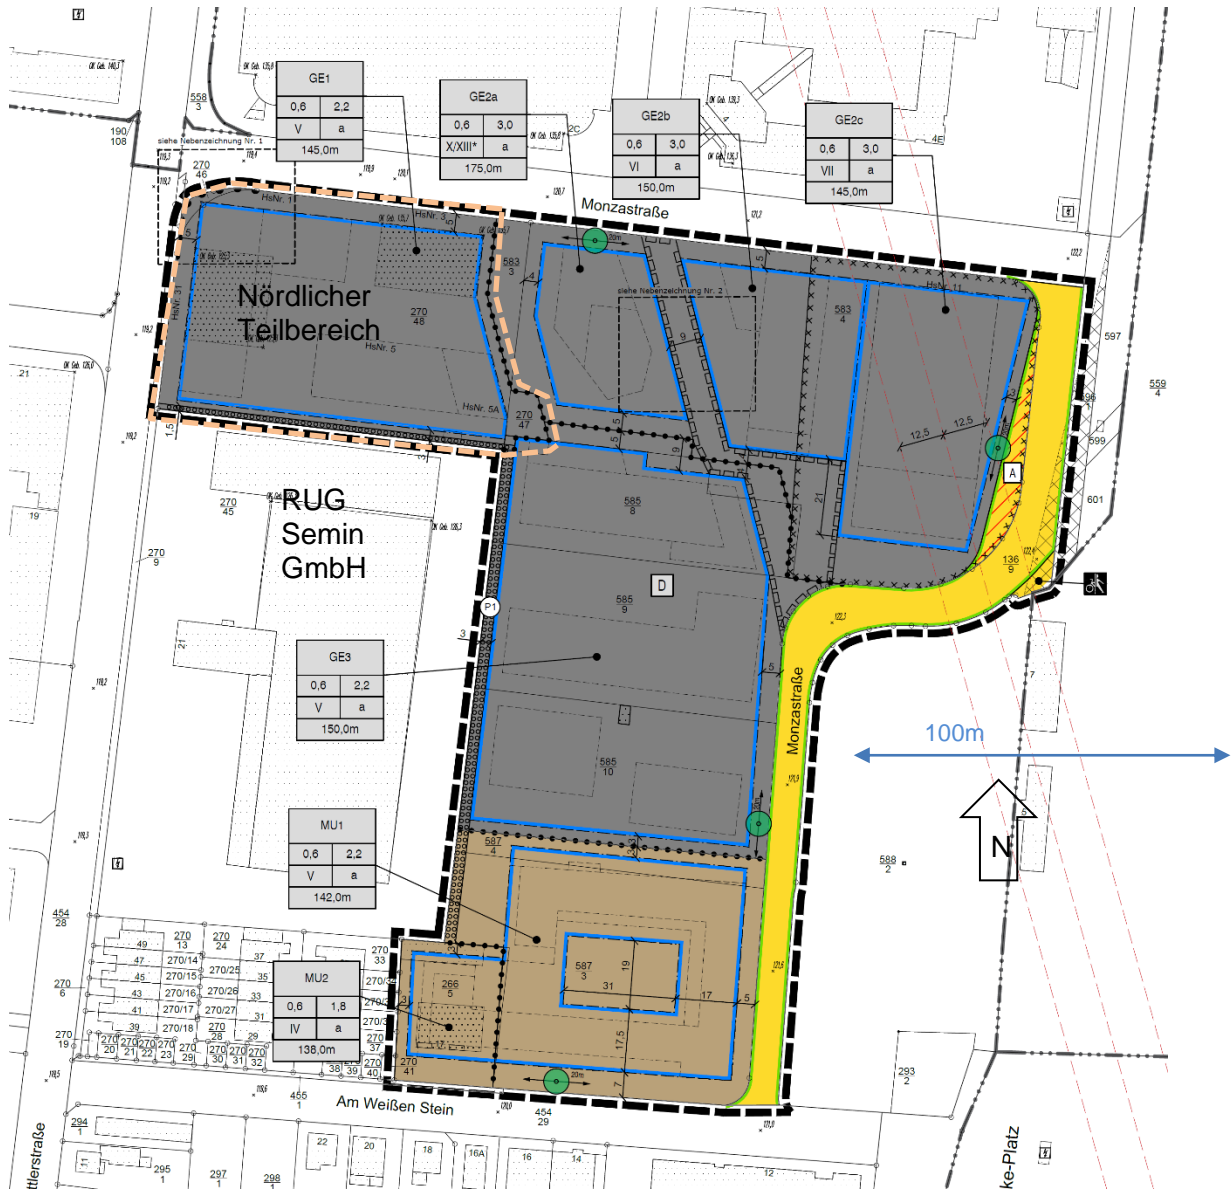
zukünftiger Bebauungsplan mit Kennzeichnung des nördlichen Teilbereichs
